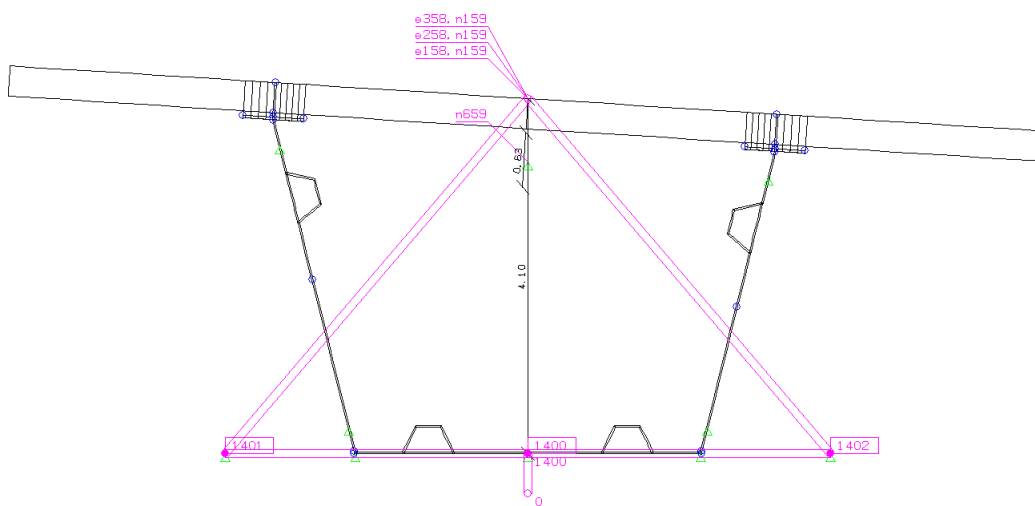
Abutment i RM Bridge. Figuren er hentet fra Bentley (2011b)
